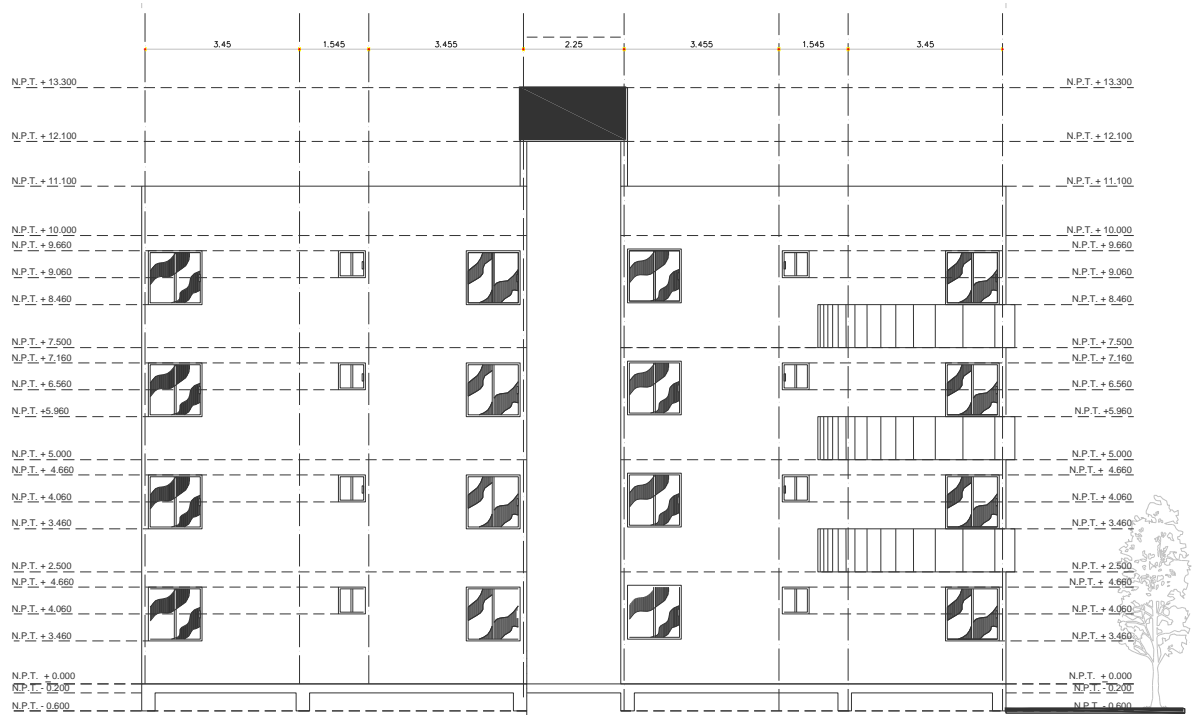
Fachada Principal del Conjunto Habitacional “Norte 70c”
